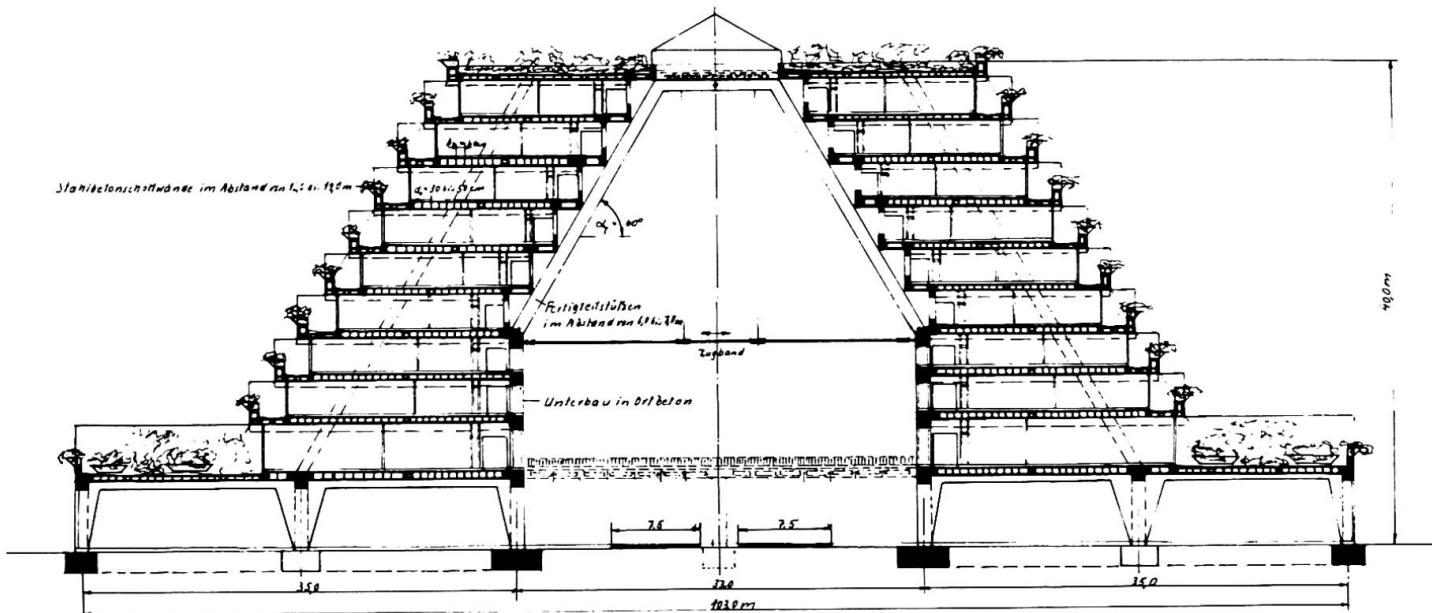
Vielgeschossiges Terrassenbauwerk auf einer Stützkonstruktion.
